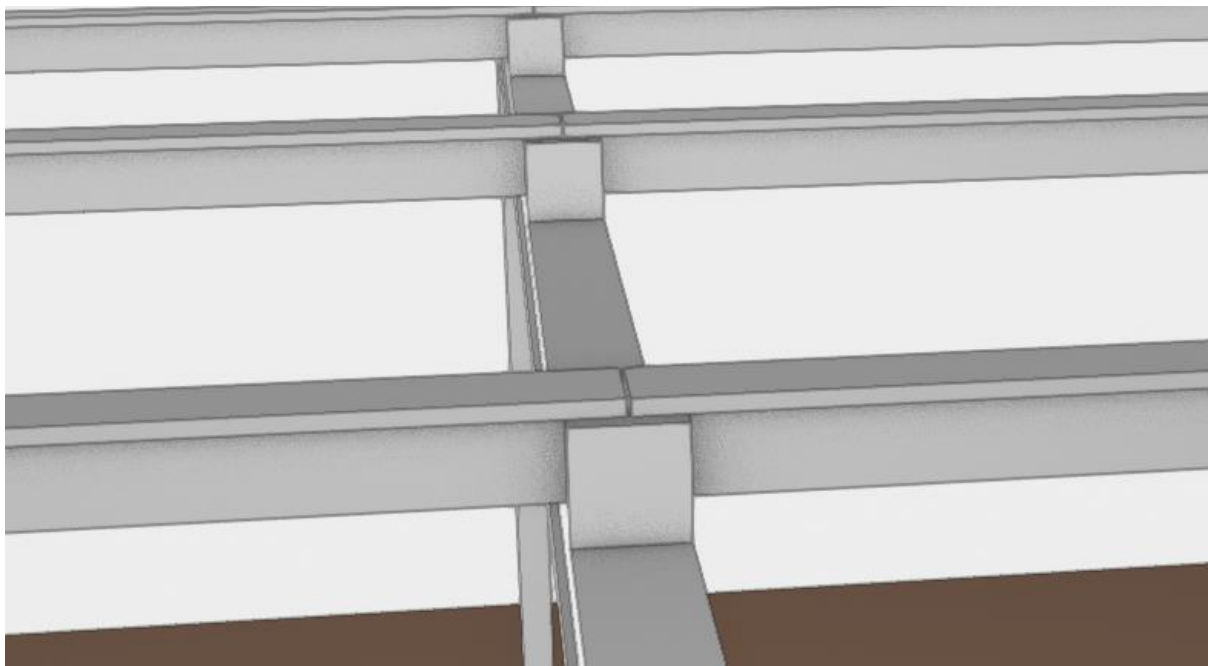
Terça pré-fabricada de concreto apoiada em calço da viga I.
